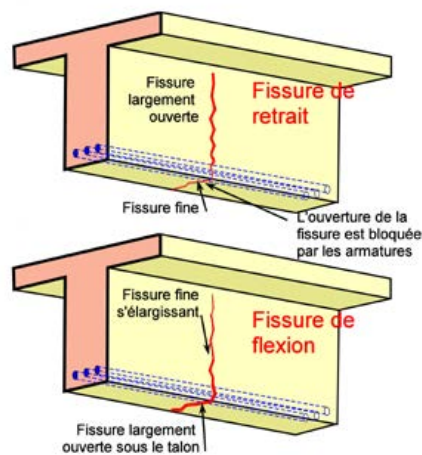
comment différencier une fissure due aux différents retraits d'une fissure de flexion
